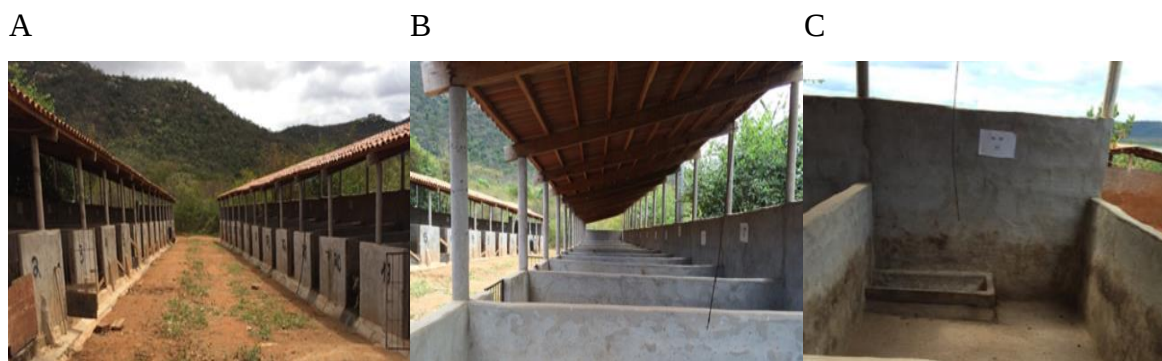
Instalação: Vista externa da instalação (A); Vista interna (B); vista interna da baia (C). Fonte: HOLANDA e BEZERRA, (2016).
